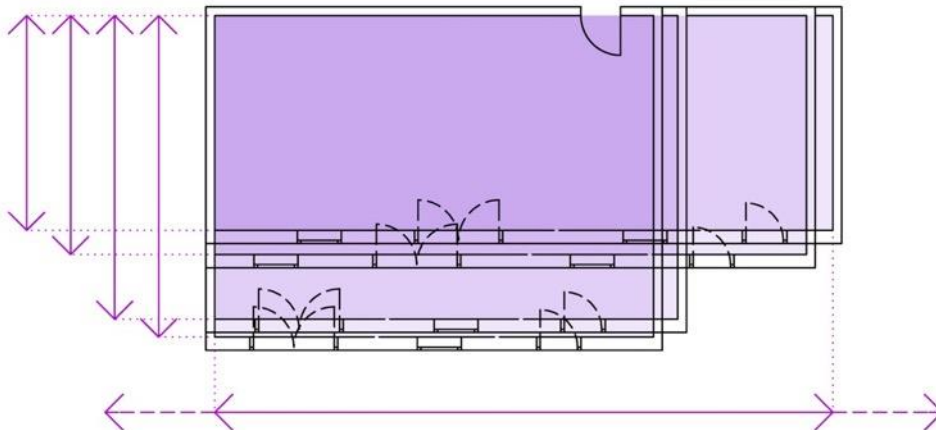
Flexible Anpassung der Grundrisse in Bausystemen aus Flächenelementen
